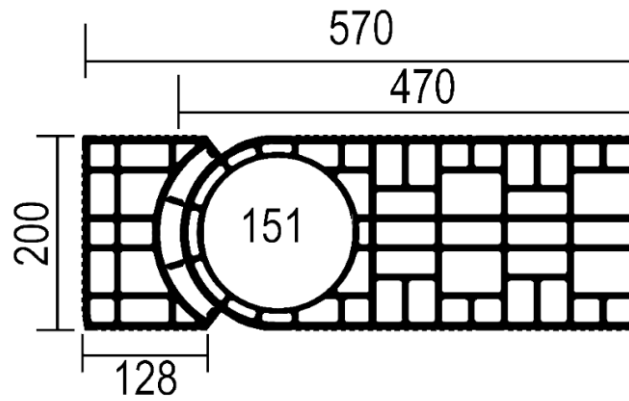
Poteau multi-angle (Diamètre réservation 150 mm)
